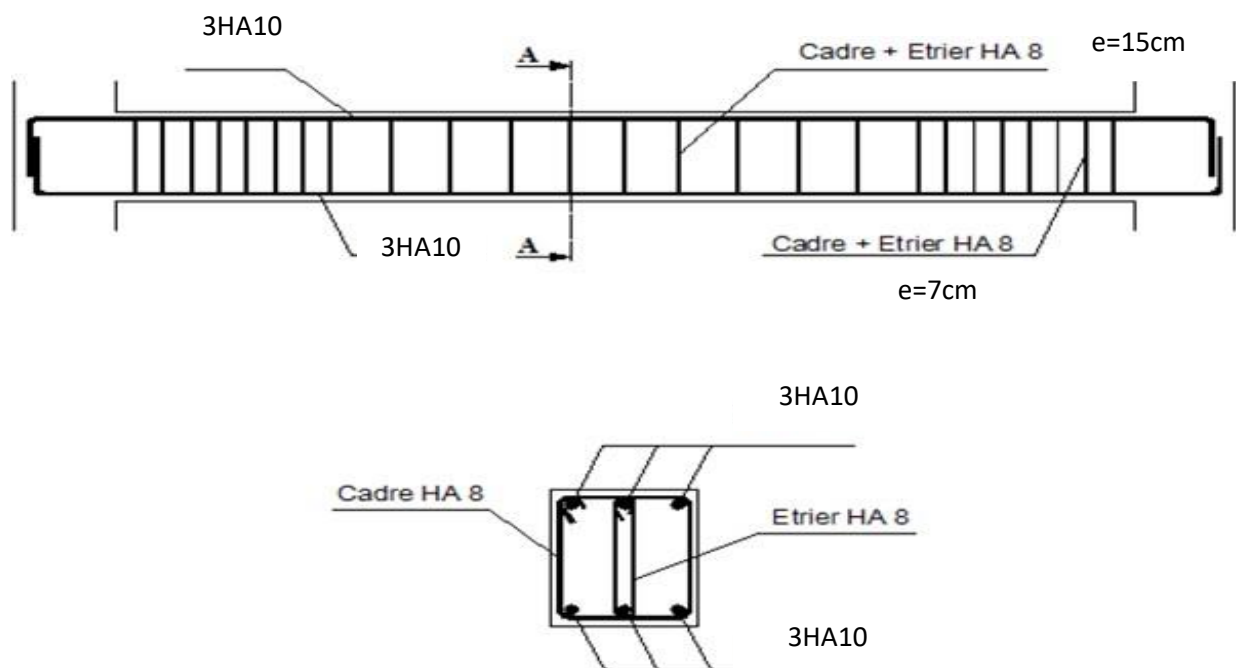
Ferrailage de la poutre de chaînage reposant sur deux appuis
